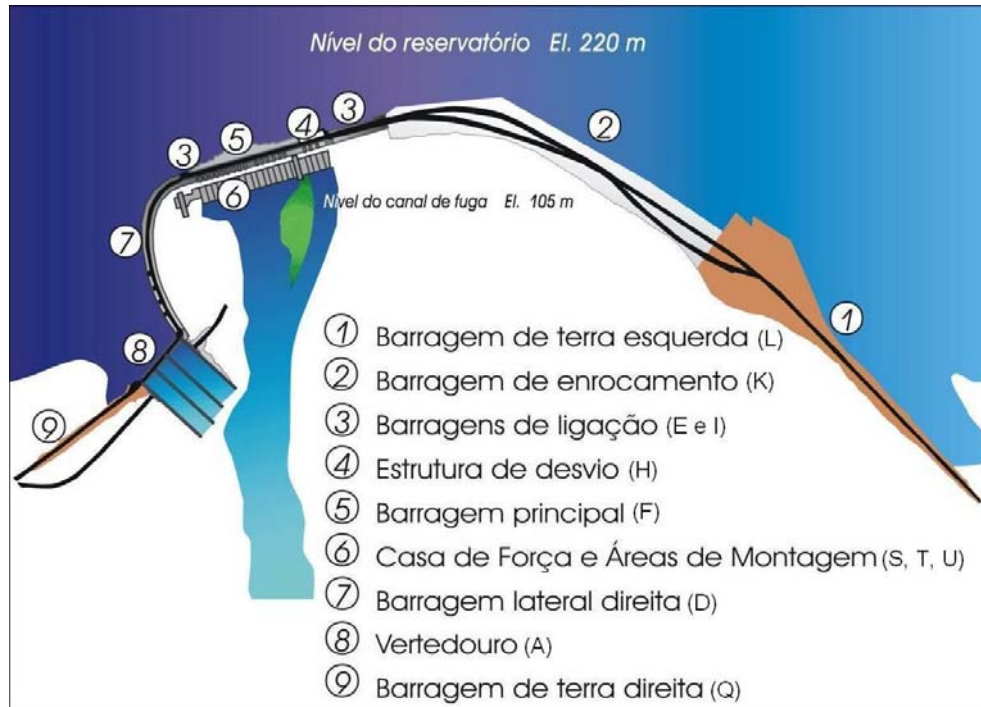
PLANTA DO COMPLEXO DE ITAIPU
